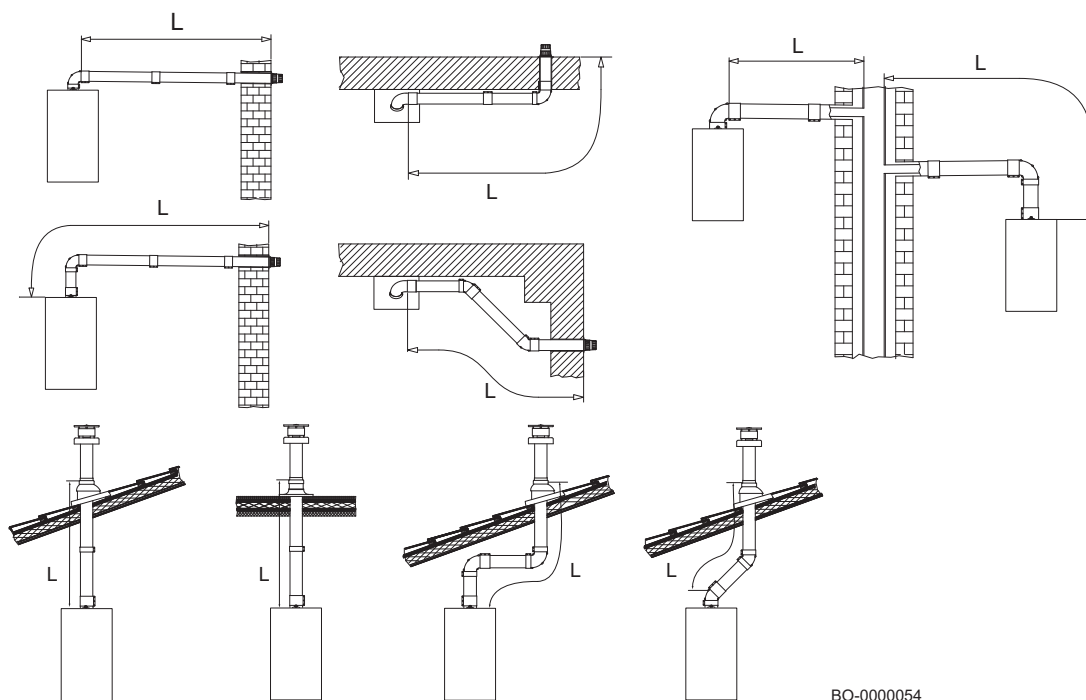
Крепёж коаксиального патрубка дымовых газов
